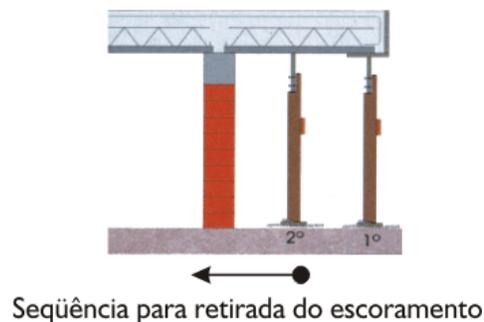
Retirada de escoramentos laje em balanço. Fonte: VIZOTTO (2003)
